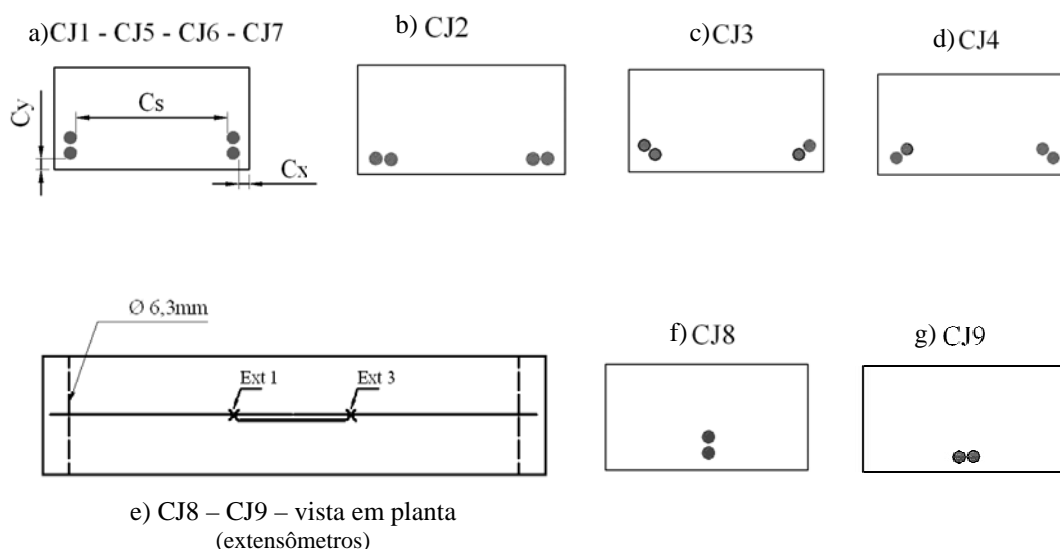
Disposição das barras nas vigas de cobrejunta – vista em corte da seção transversal
